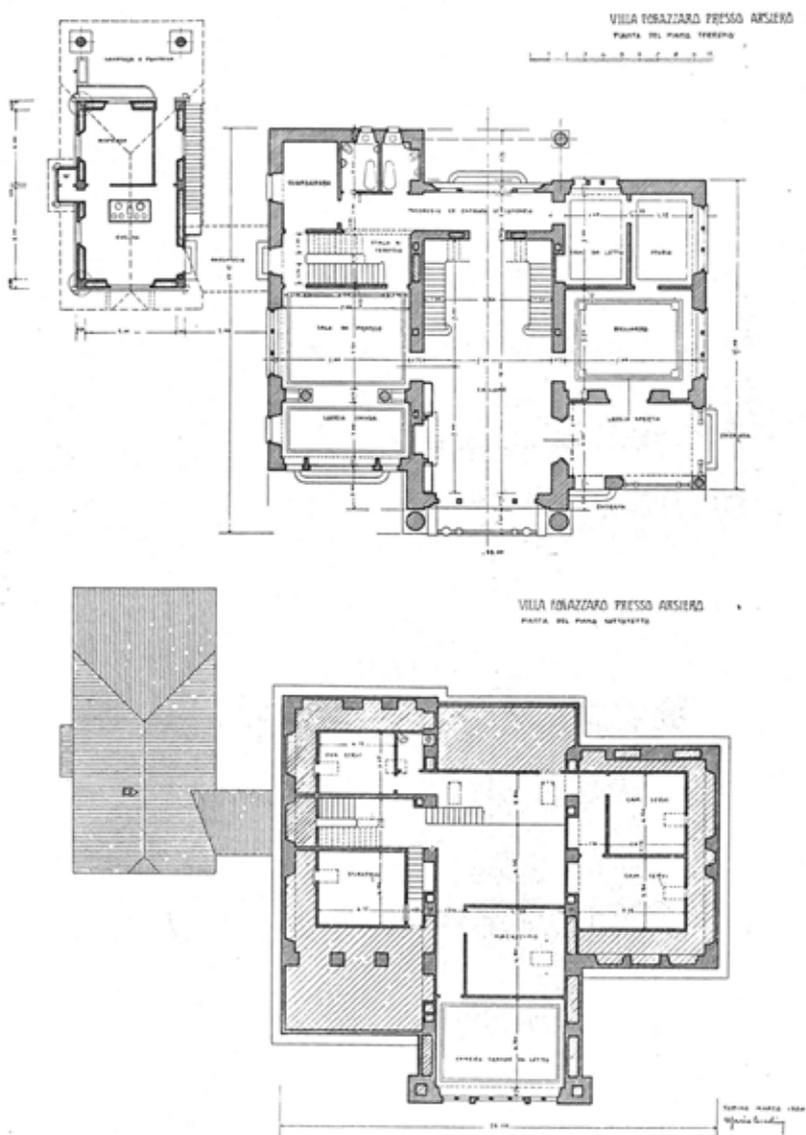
Villa La Montanina, *Cottage*: piante del piano terreno e del sottotetto del *cottage*.
